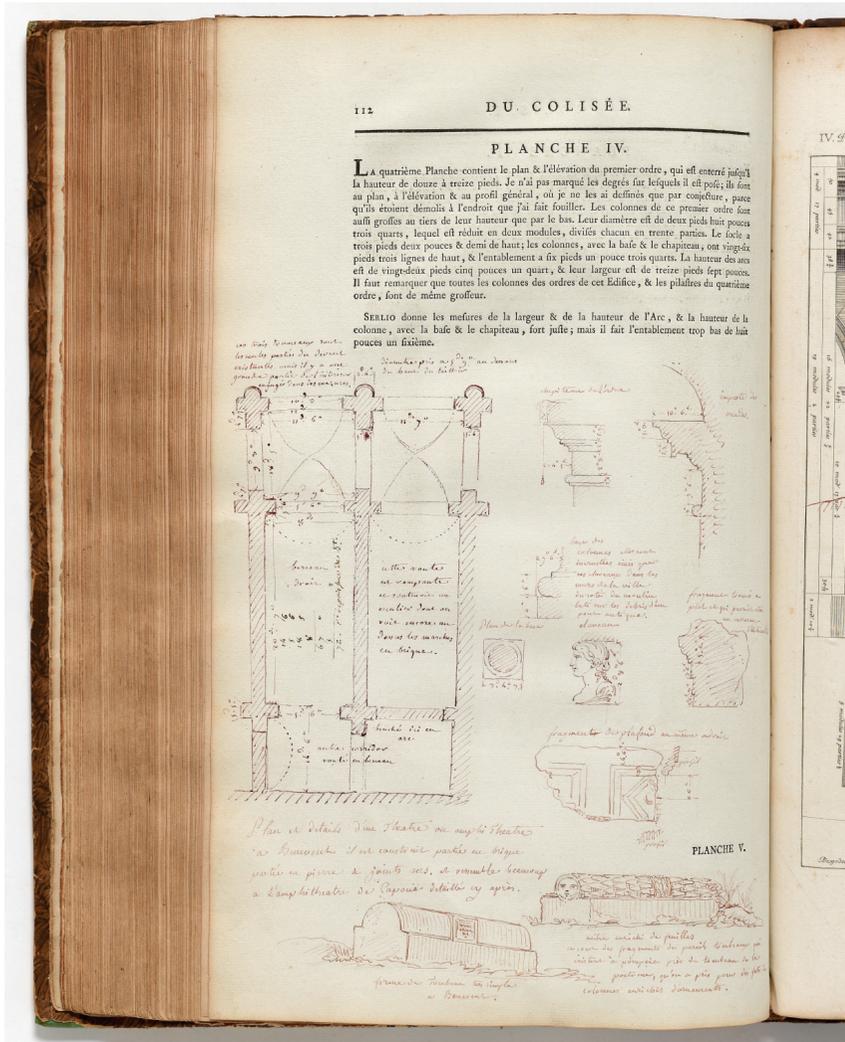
(below) Plan et details d'un Theatre ou amphitheatre a Benevent
